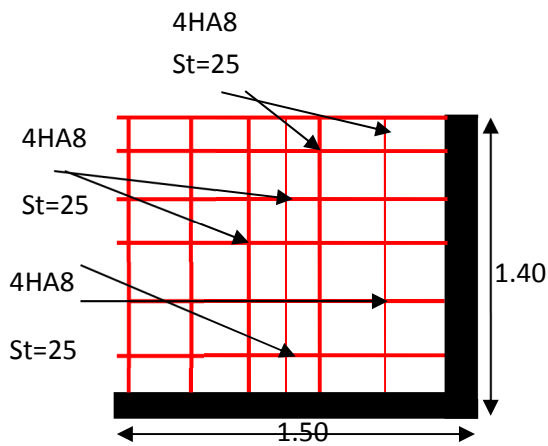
Schéma ferrailage de dalle sur 2 appuis (Balcon)
